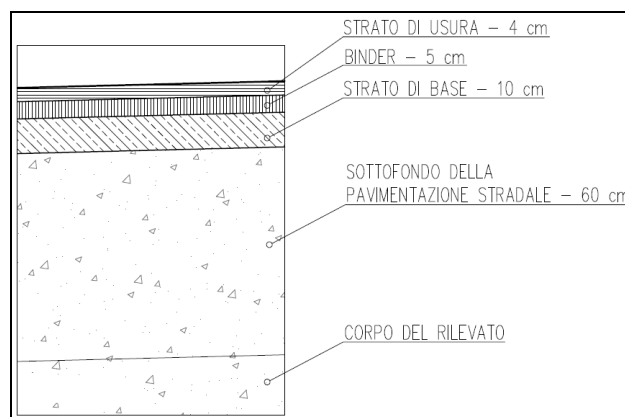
PARTICOLARE PACCHETTO STRADALE
